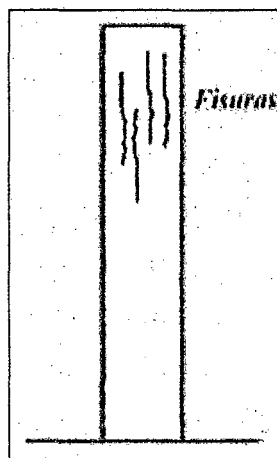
10. Fisuración longitudinal en columnas por compresión. Fuente: (Stuardo P., 2008).
